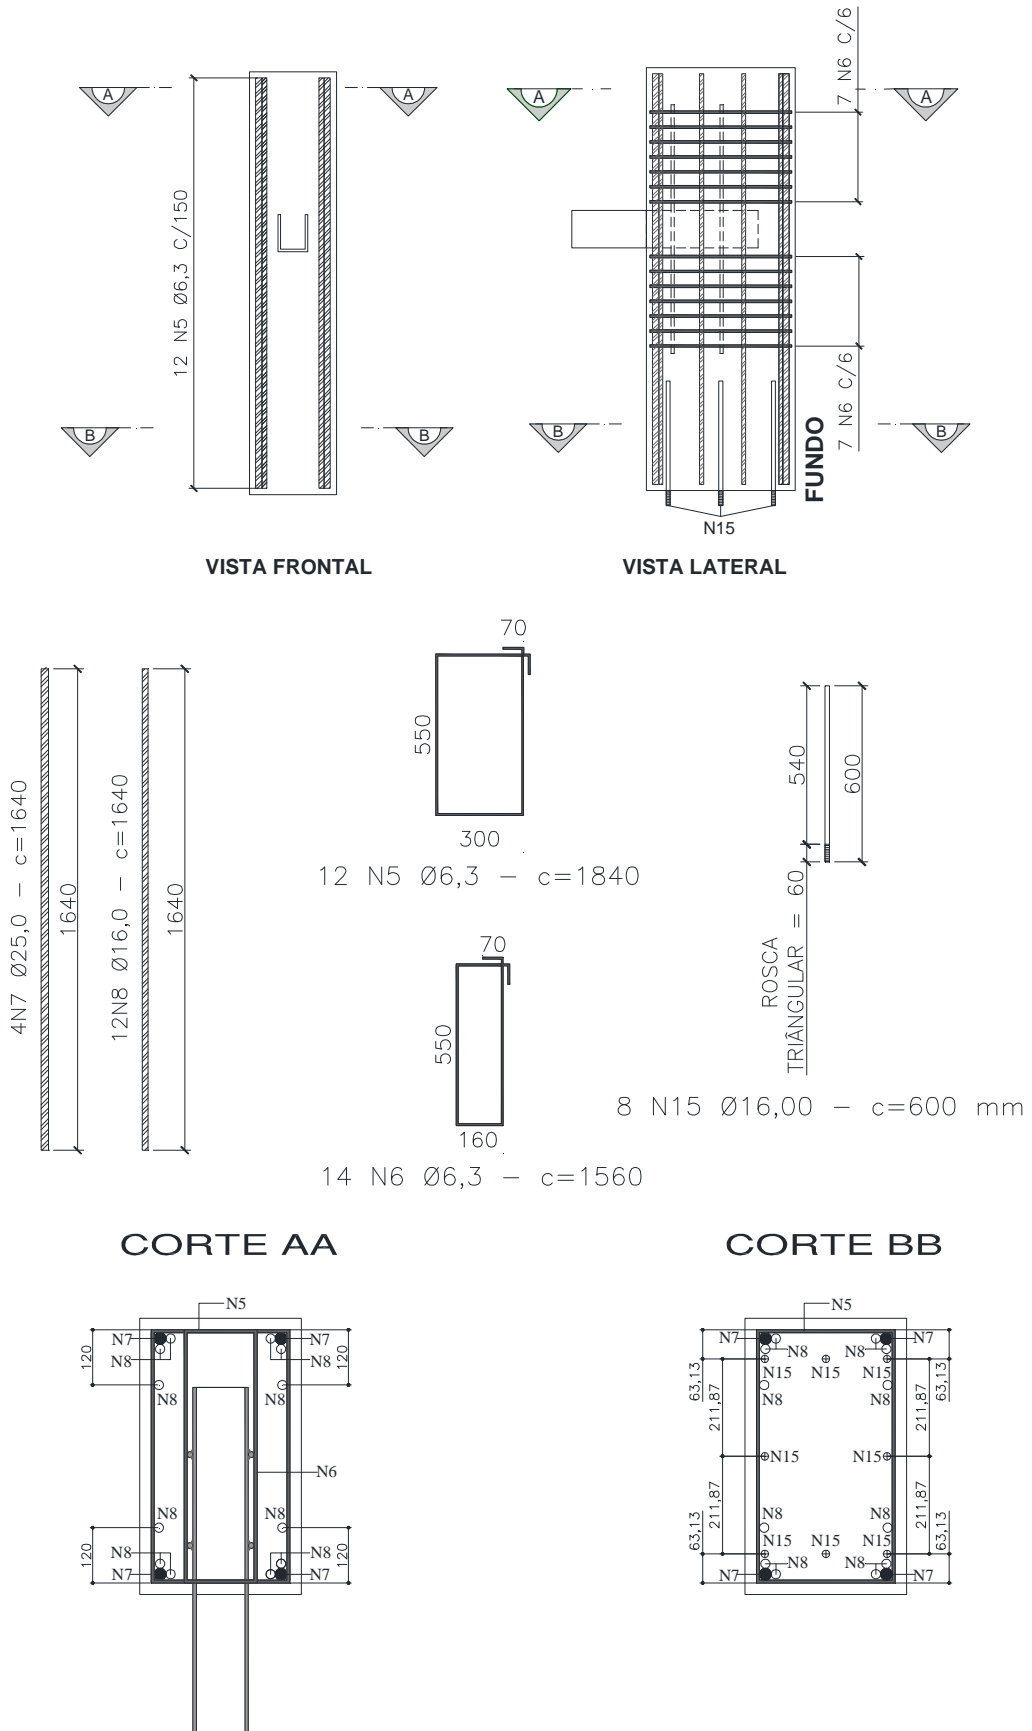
Armaduras do pilar pré-moldado tipo B (consolo-7,5).
